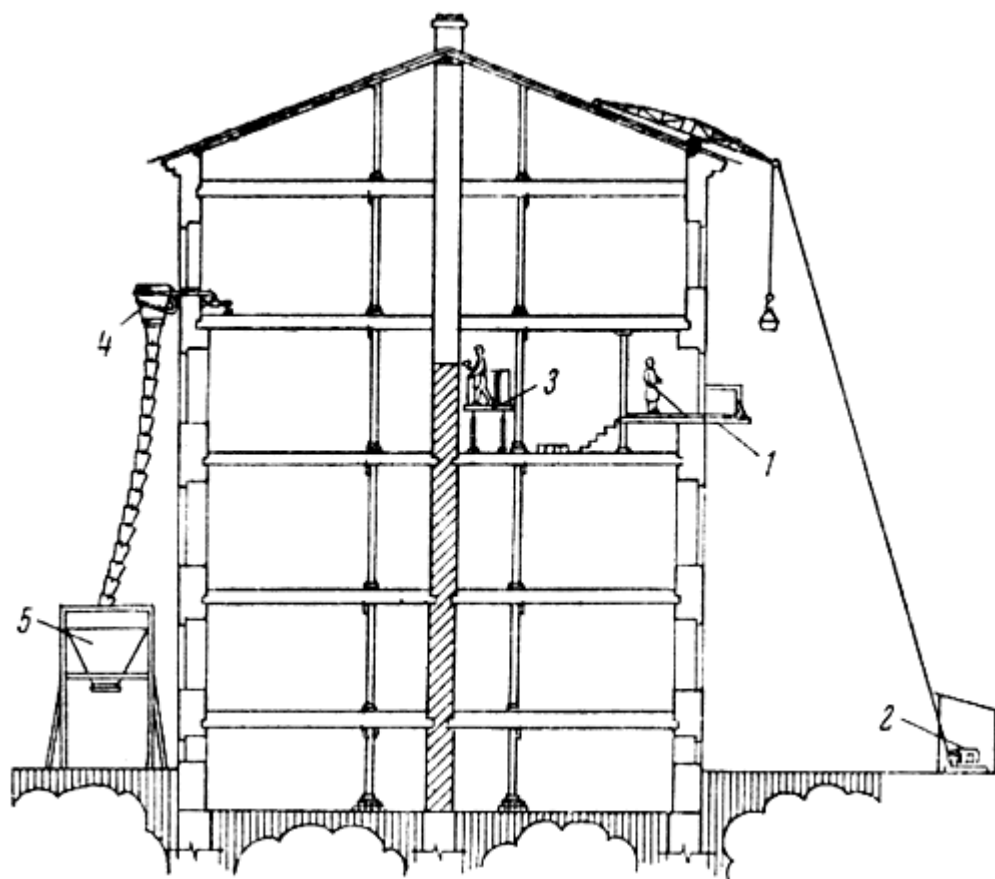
Общая схема организации работ по перекладке участка стены с сохранением существующих перекрытий
